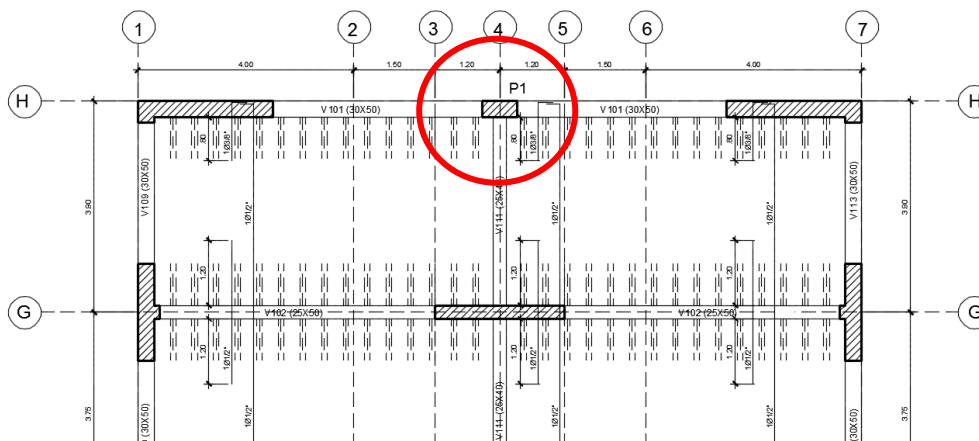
Ubicación de columna P1 en edificio convencional
